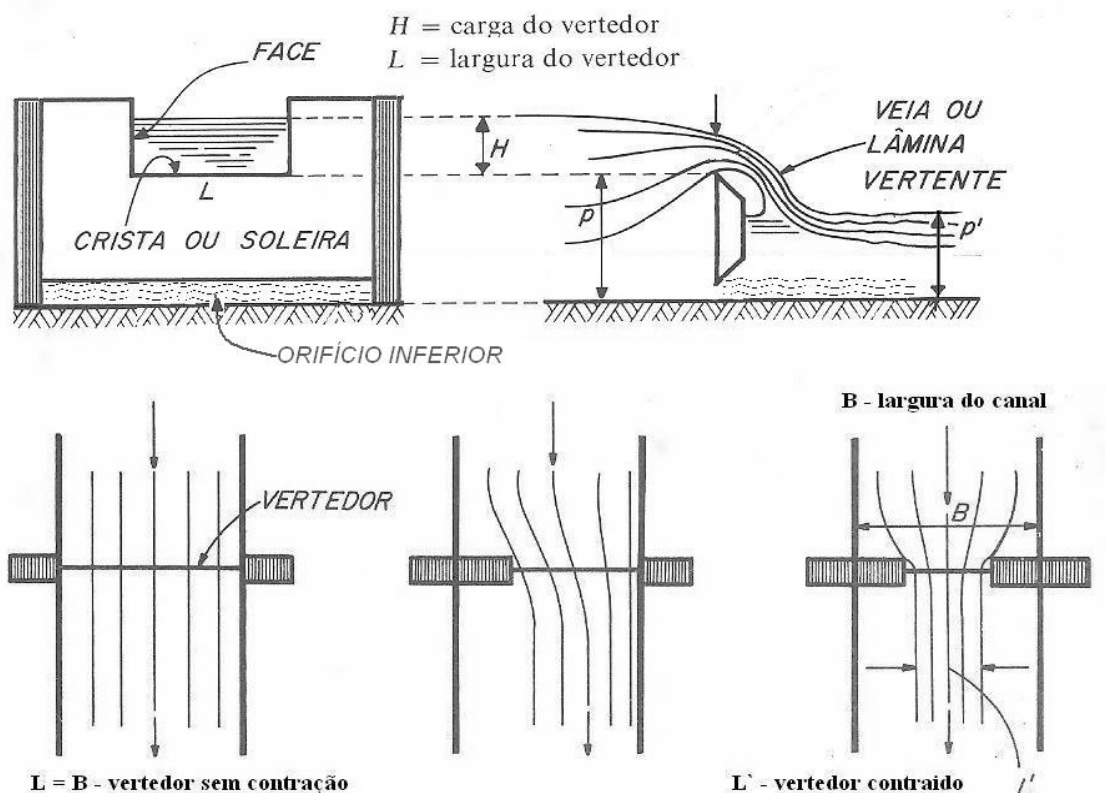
4 - Viga de retenção e canal (Adaptado de NETTO e ALVAREZ, 1973).
